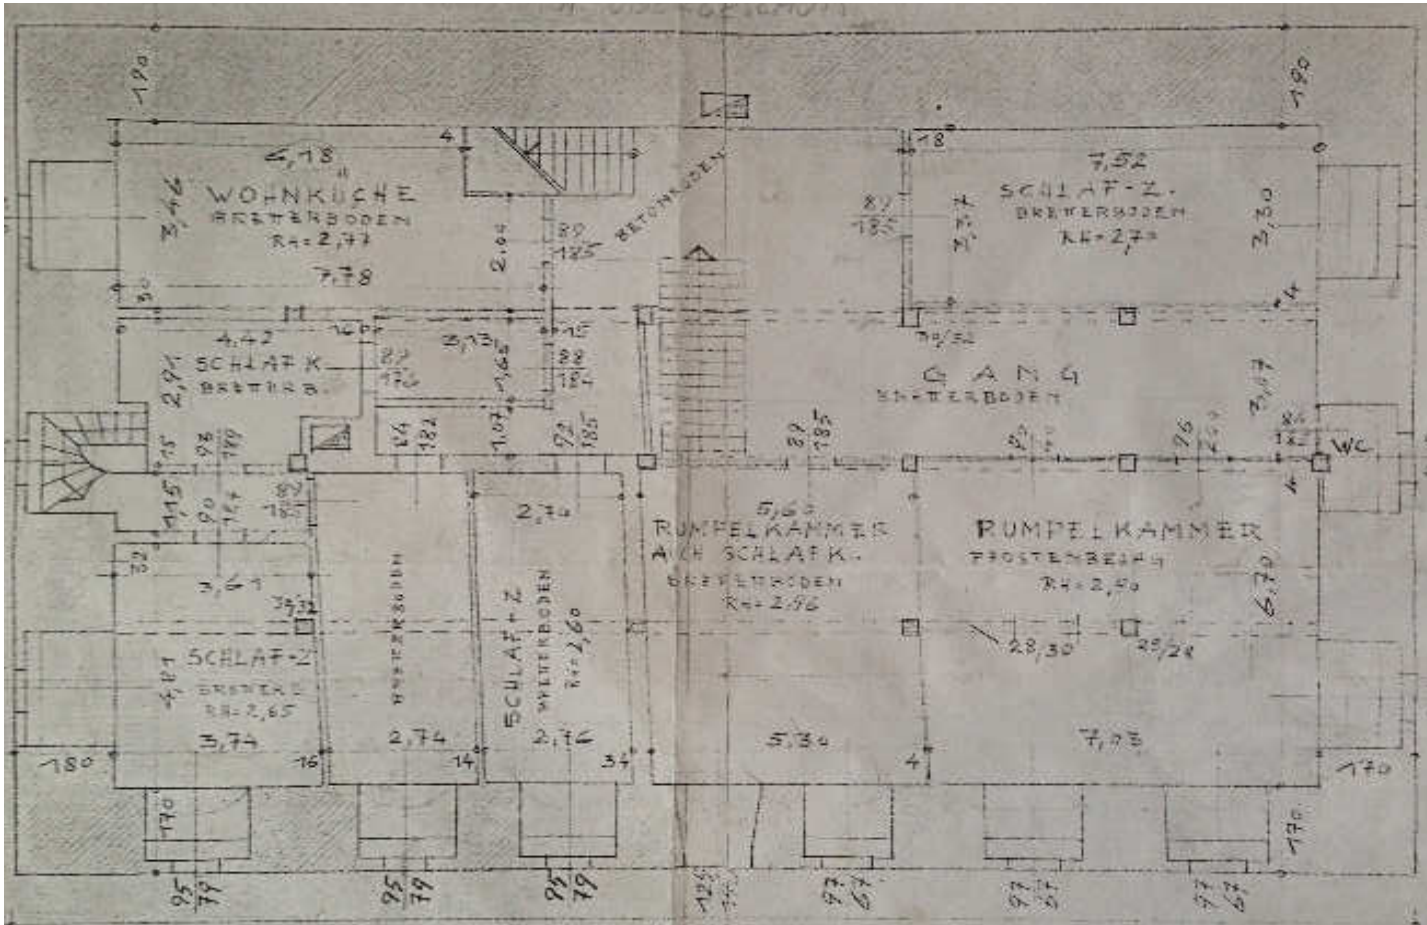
Bestandsplan 1959 - Grundriss erstes Speichergeschoss
